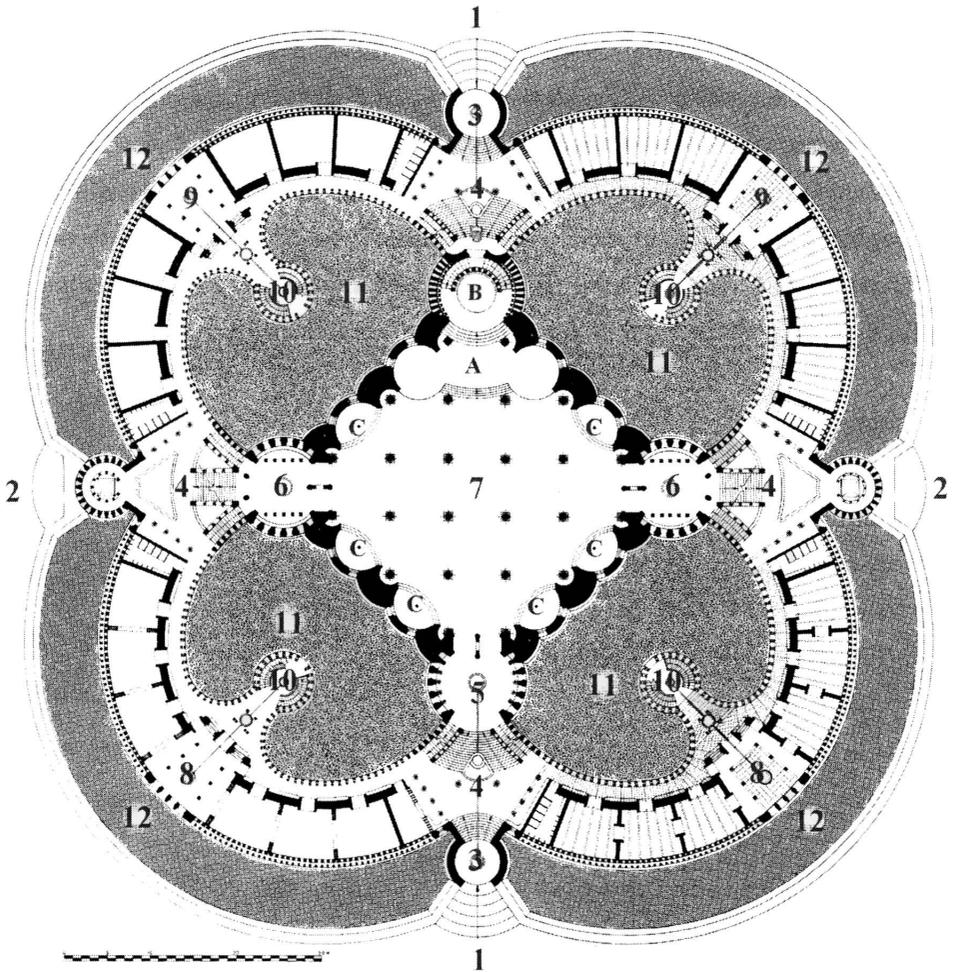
Proyecto de Tánger, Planta baja interpretada por T. Torii
